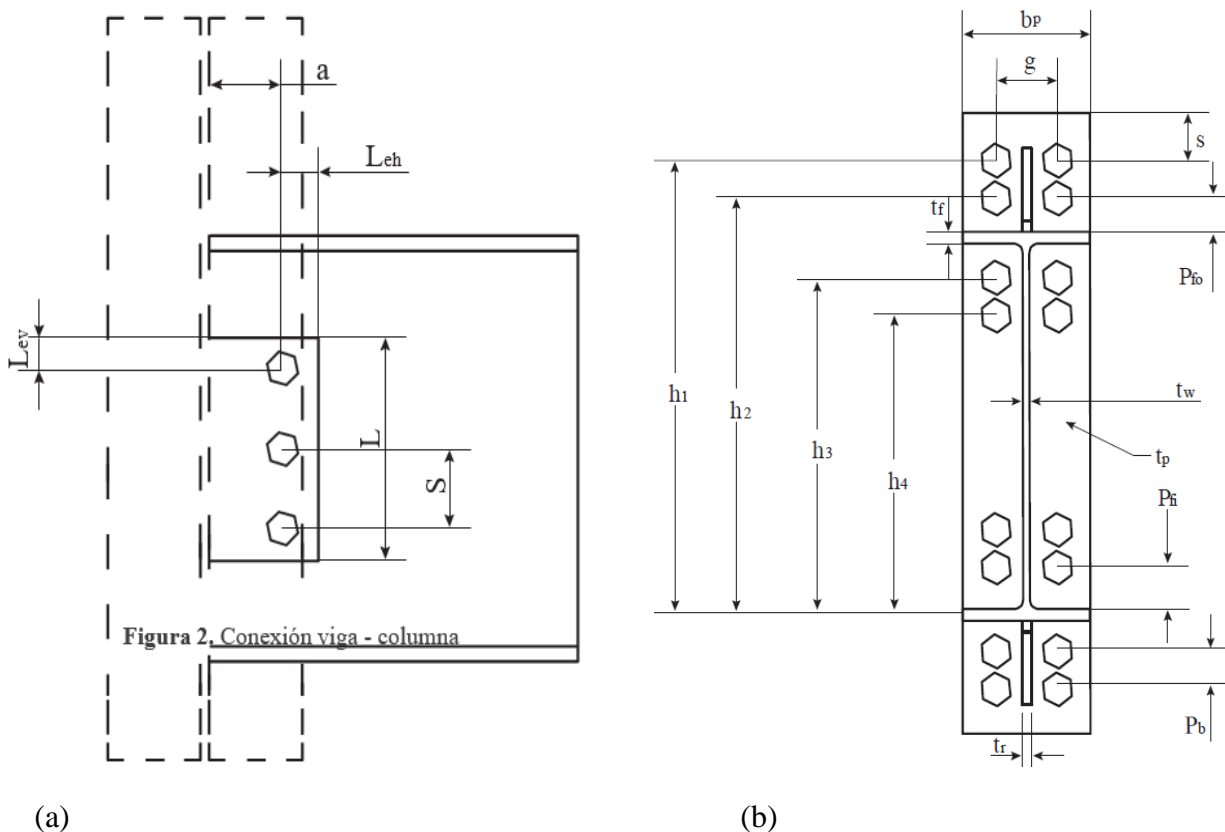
Detalle de conexión viga-columna (a) conexión simple de una viga con una columna (conexión simple o de corte) (b) conexión compuesta entre dos vigas y una columna (conexión a momento)
